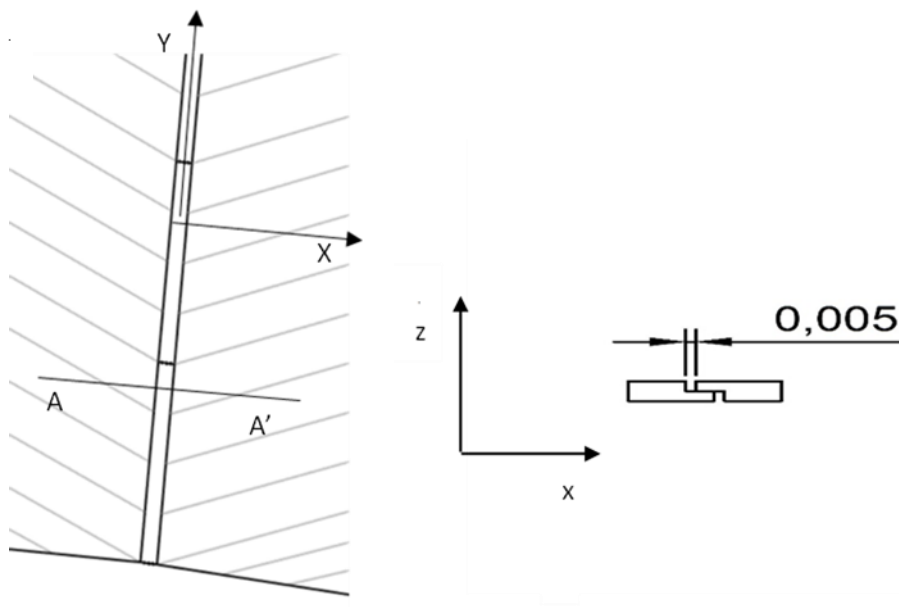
Vista em planta das ligações e vista frontal das ligações (corte A-A')
